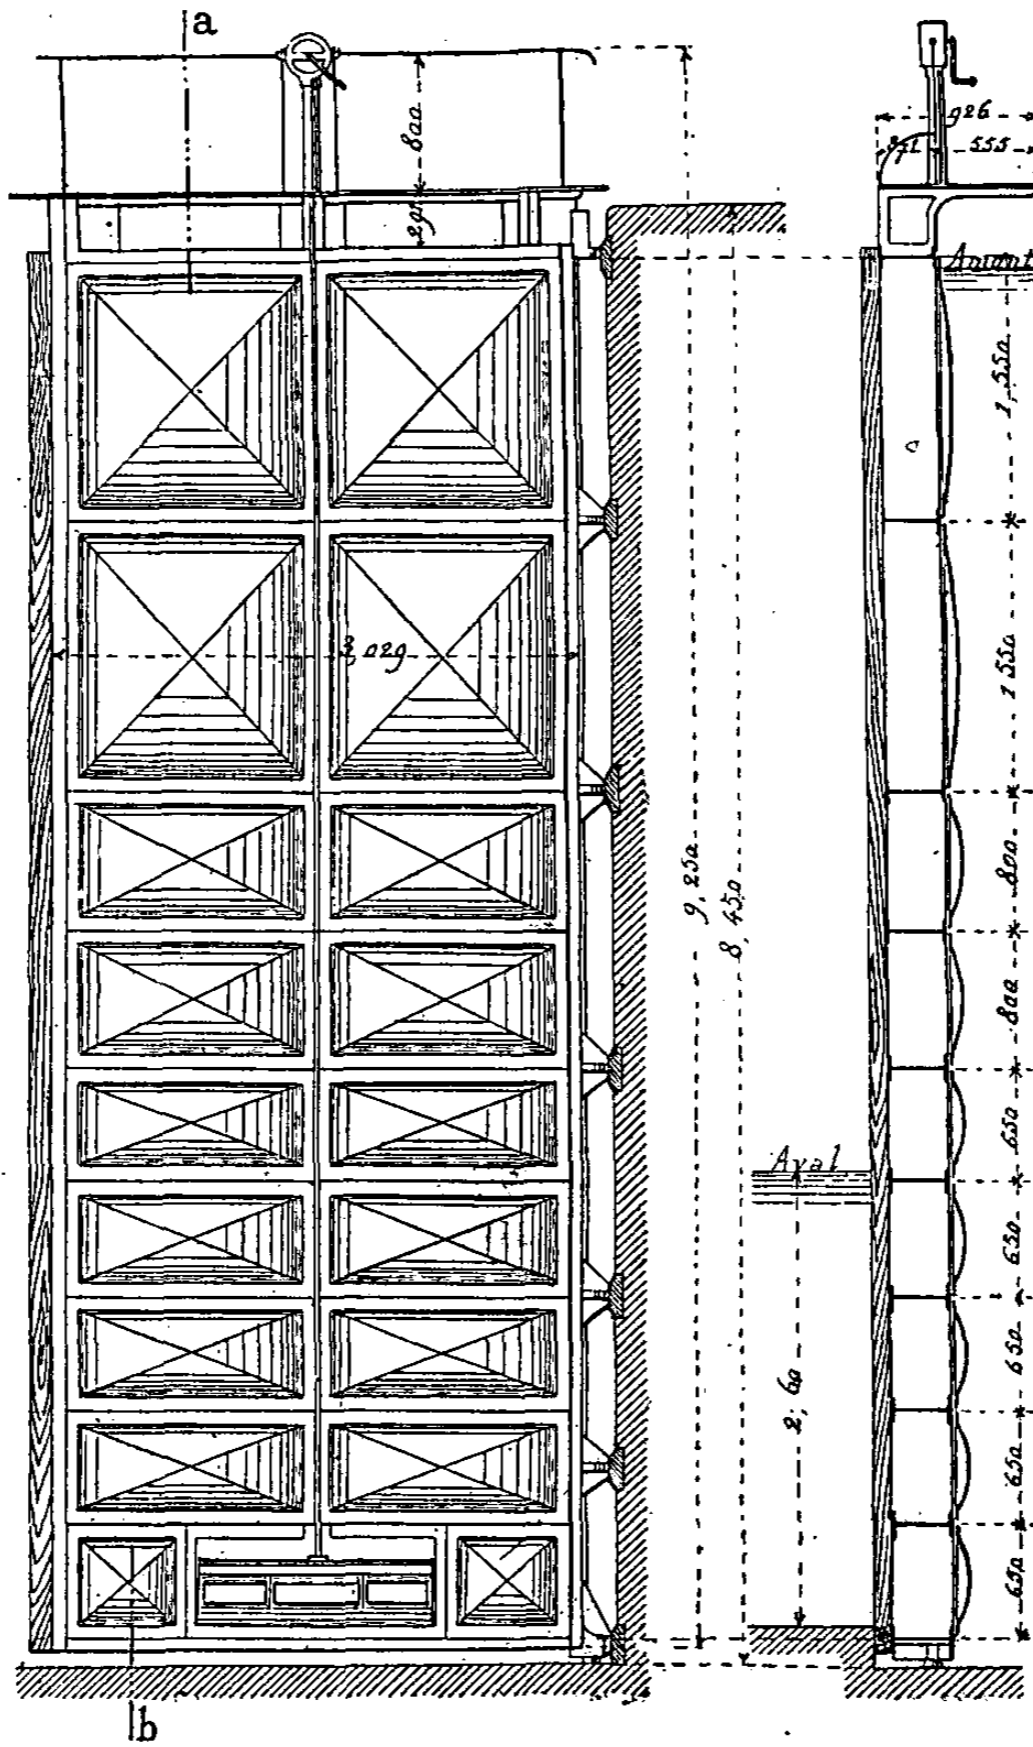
Elevation d'amont et coupe transversale d'une porte d'aval.
